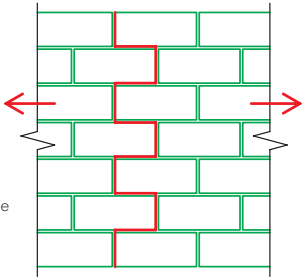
Растяжение кладки по перевязанному сечению
